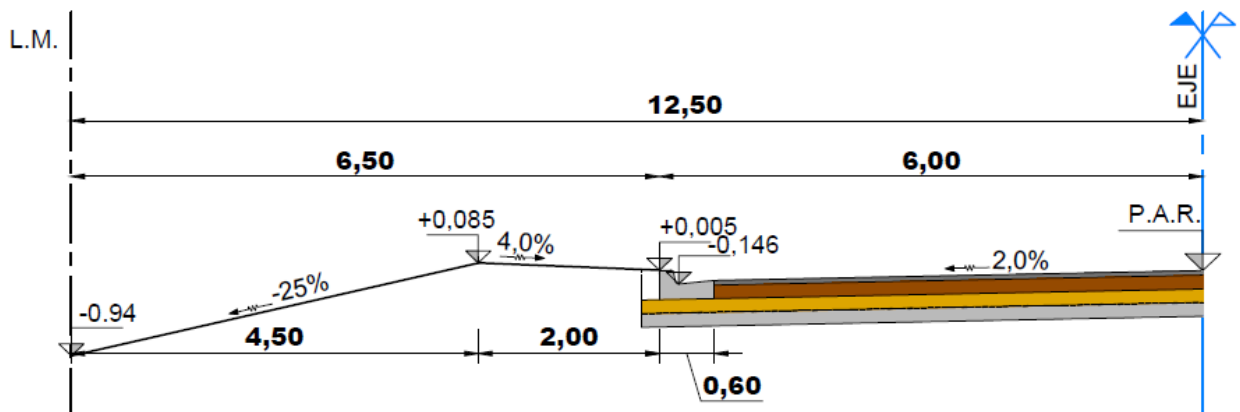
Esquema del perfil transversal para calles de doce metros de ancho.
